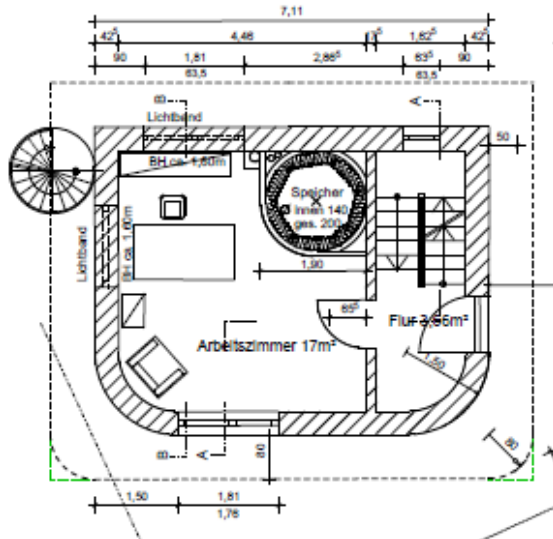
Grundriss vom Sonnenhaus (EG-Büro)
